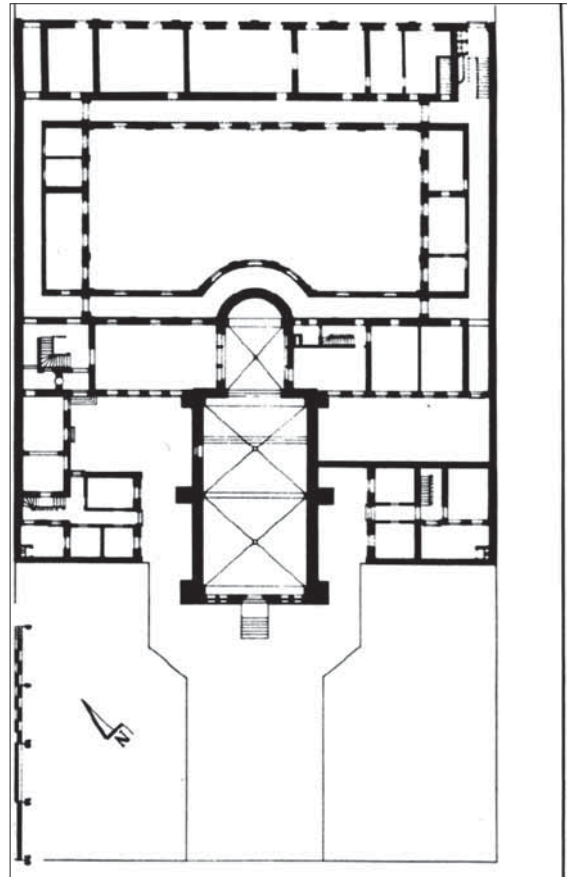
Grundriss des Karmelitenklosters in Aachen
